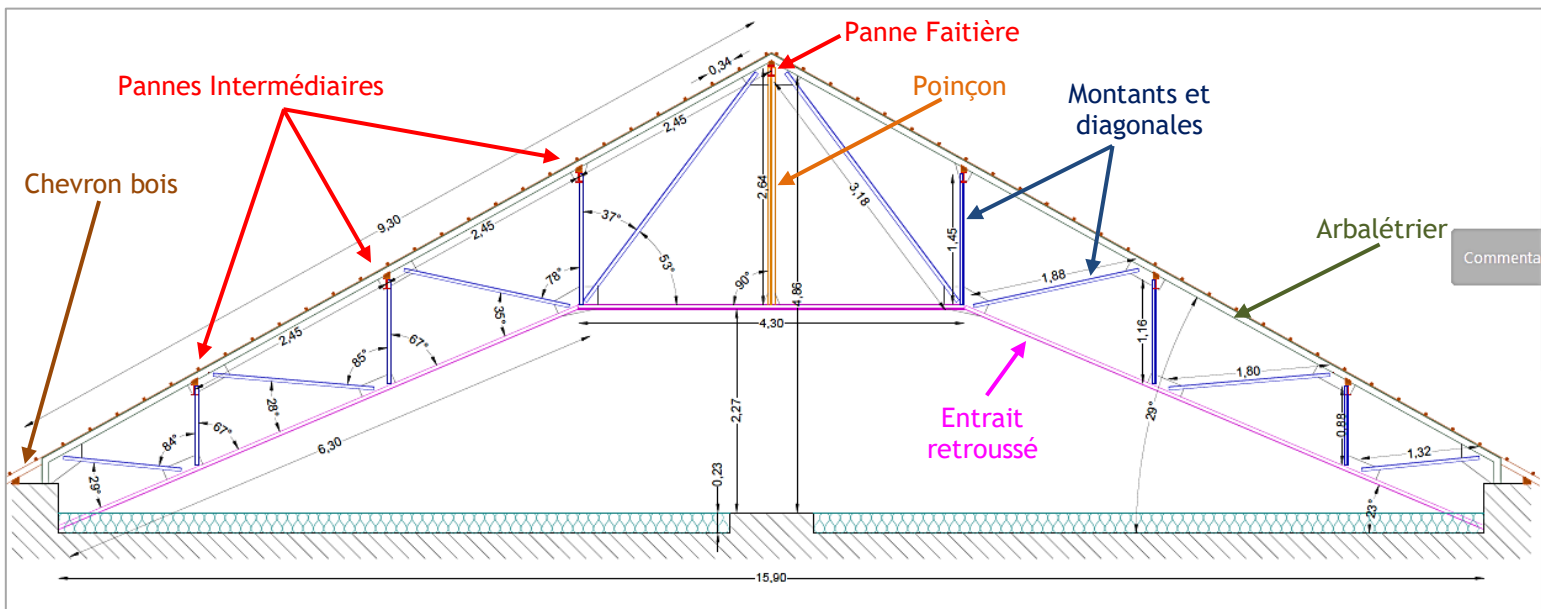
Coupe AA' de principe d'une ferme du bâtiment 3 (unités en m)
